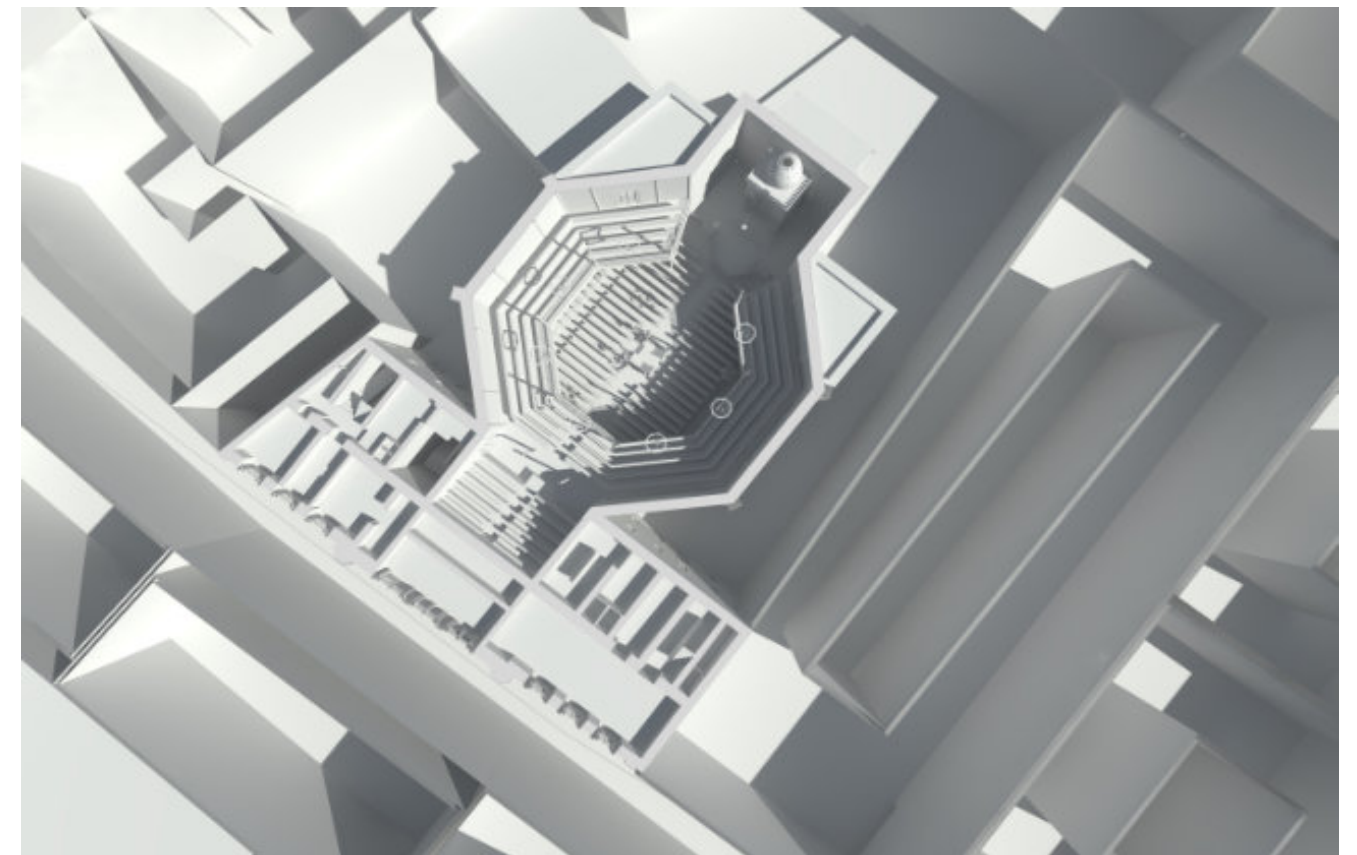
30.: 3D Grundriss - 1. Obergeschoß, Weißrendering.
